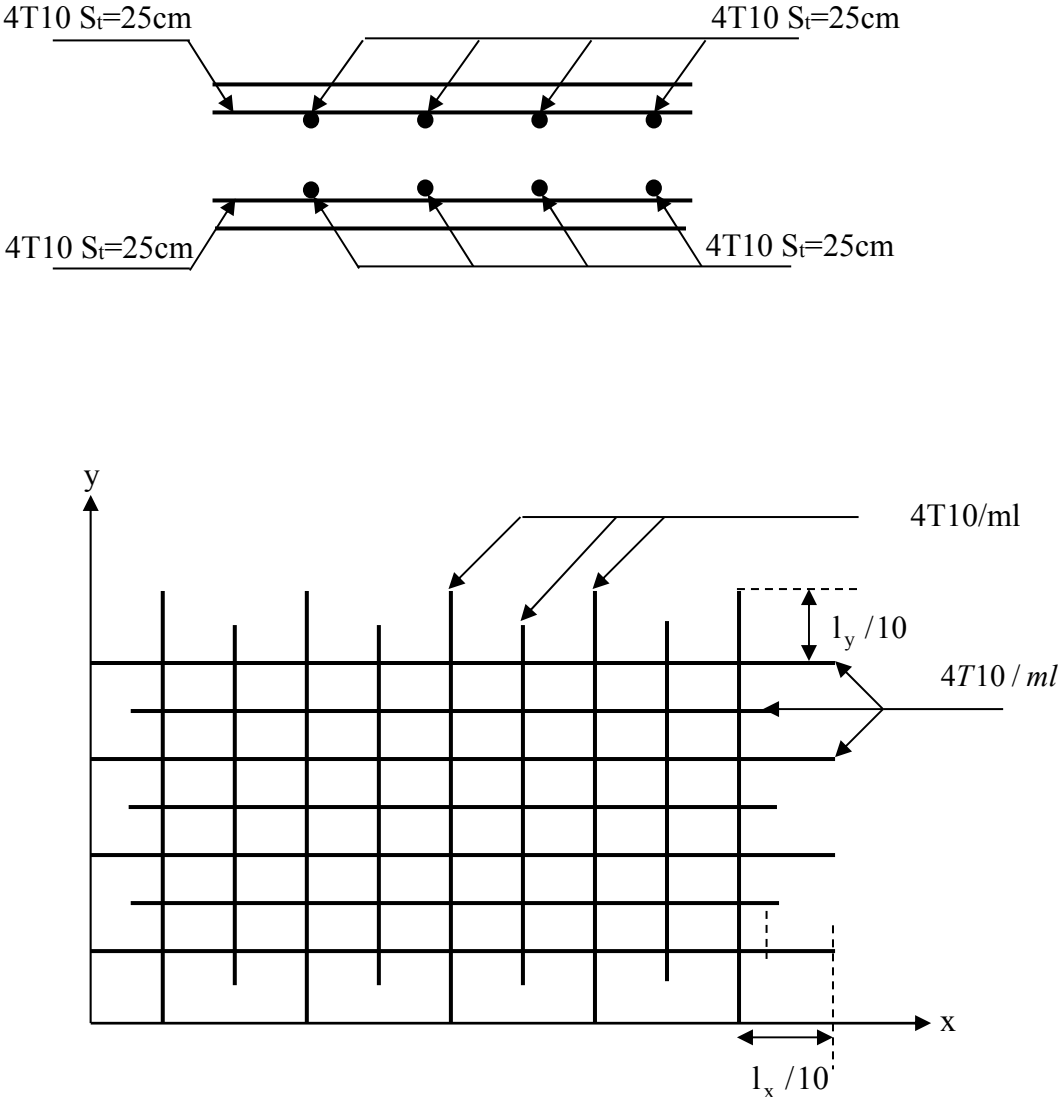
Schéma de ferrailage de la dalle de l'ascenseur
